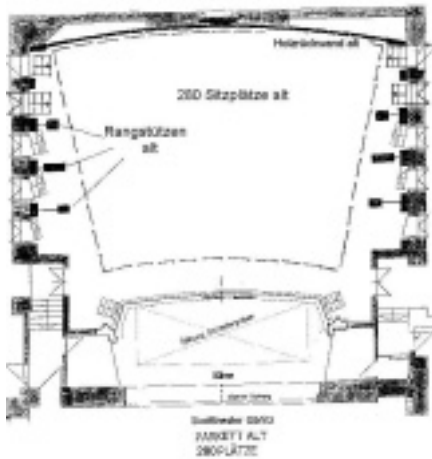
Grundriss Saal vor dem Umbau
